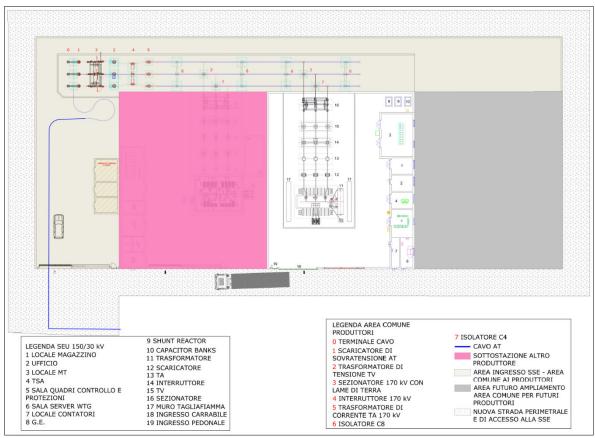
Planimetria elettromeccanica della SEU 150/30 kV all'interno della SEC
